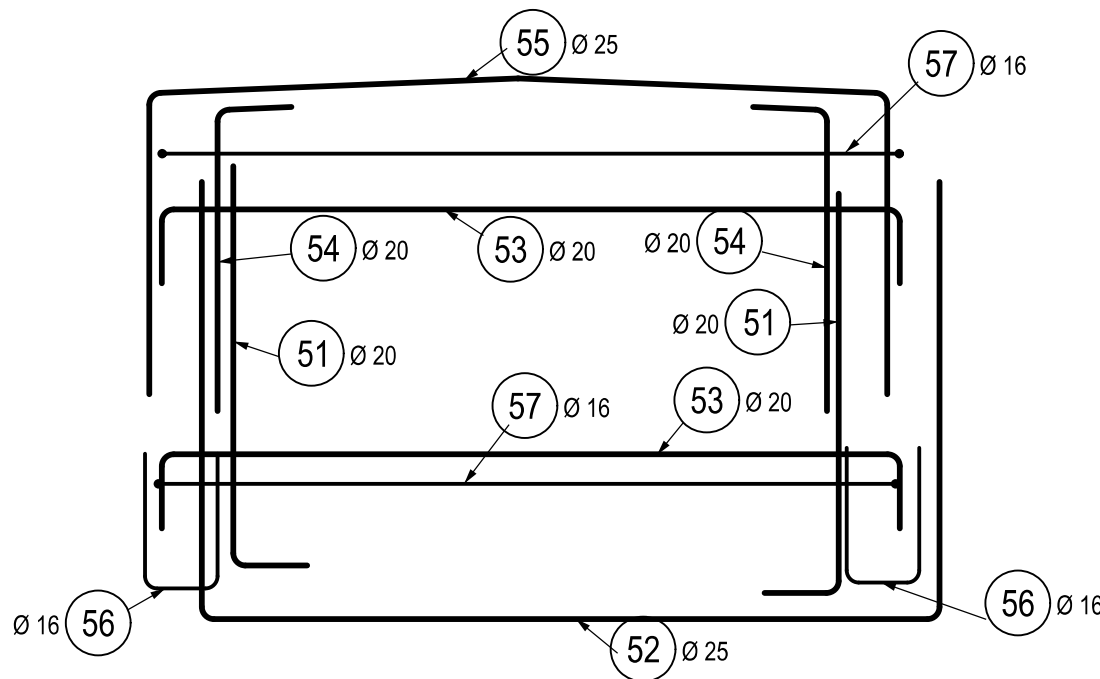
DETAIL VÝZTUŽE POD KOTVOU ZÁVĚSU, 1:25
